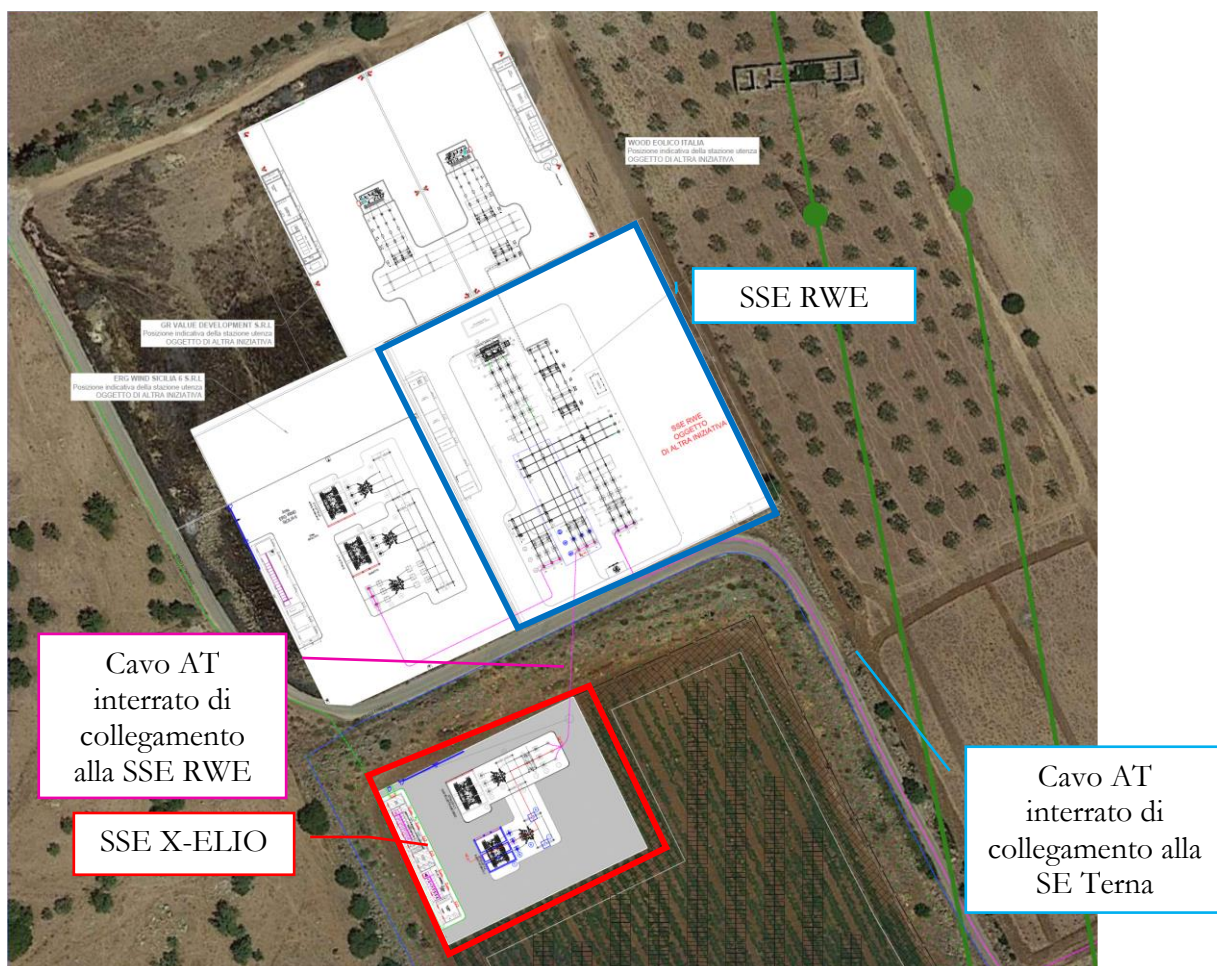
Planimetria con individuazione nuova SSE e elettrodotto di collegamento alla SE Terna esistente
